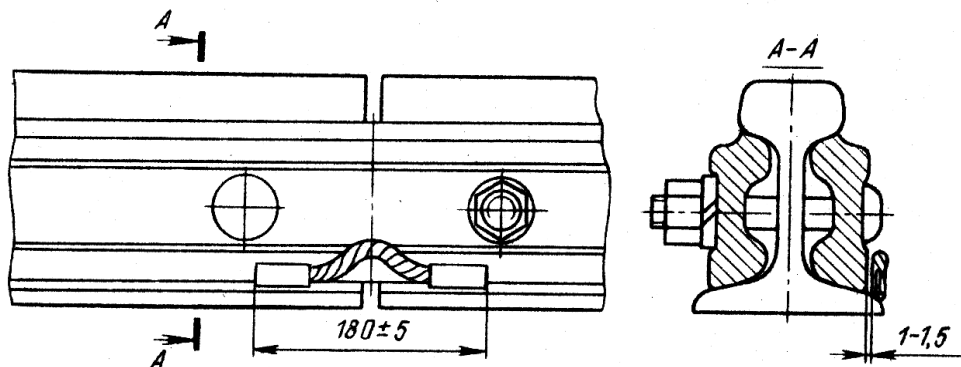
З'єднувач, приварений до верхньої грані підшви рейки
